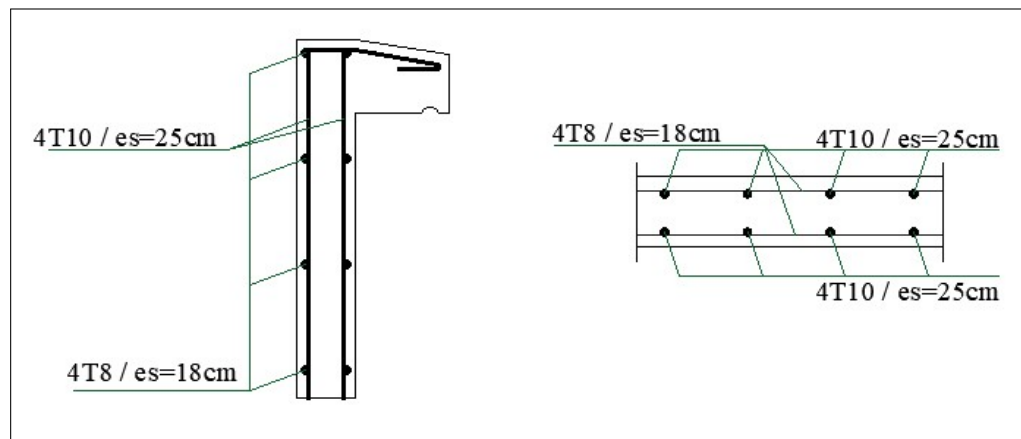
Schéma de ferrailage de l'acrotère.
